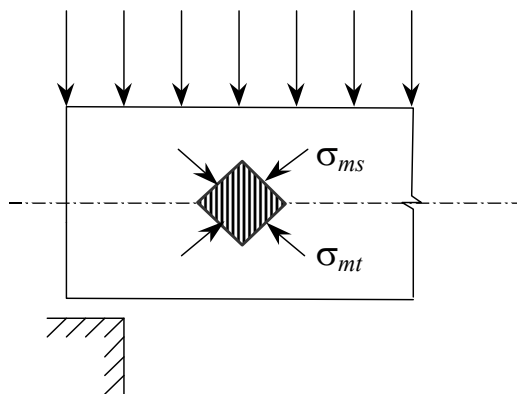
Главные напряжения в бетоне у опоры балки
